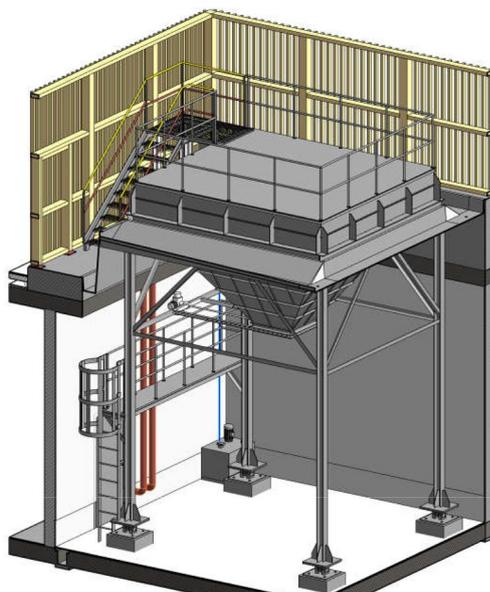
Tolva de almacenamiento de fango deshidratado. Vista 3D
